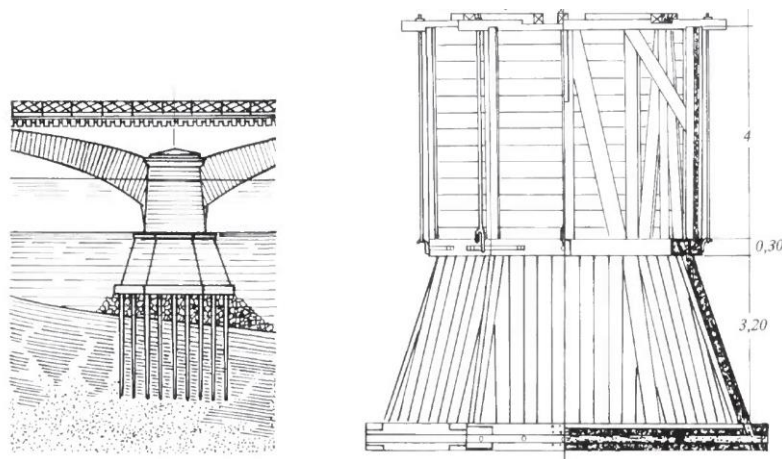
Fondazione realizzata facendo uso della tecnica del cassone affondato nel ponte Saint-Esprit a Bayonne (risalente alla metà del XIX secolo): elevazione di una pila e della sua fondazione (a sinistra), elevazione del cassone (a destra). [18]
